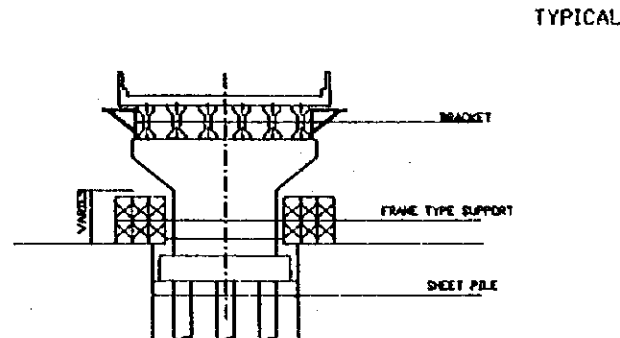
Autopista Sur. - Cruce elevado Típico
